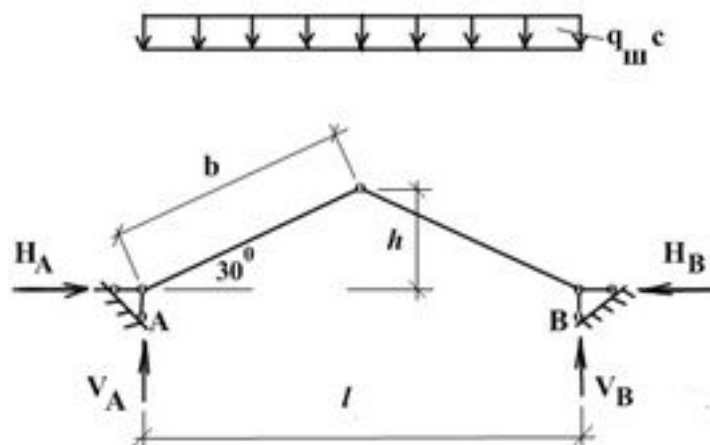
Принятая расчётная схема шпросов: $q_{ш}$ – снеговая нагрузка на горизонтальную проекцию кровли;
